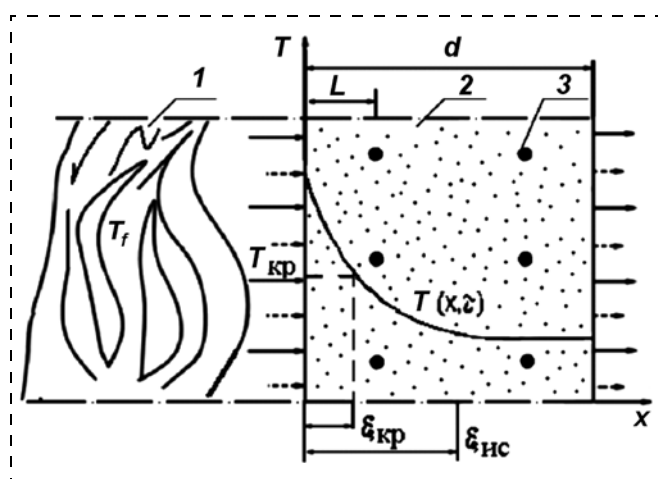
Типовая теплотехническая схема элемента железобетонной конструкции:
